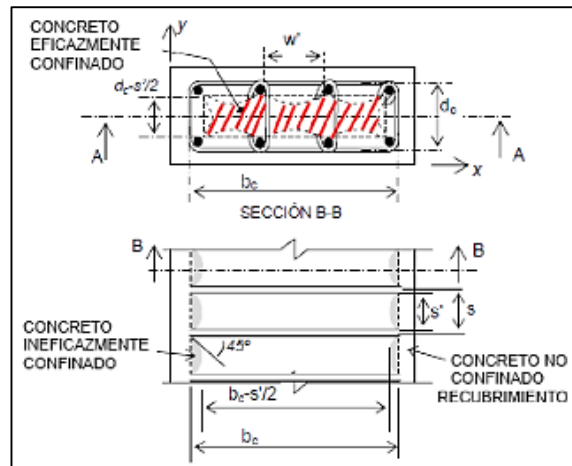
Secciones transversales tipología del refuerzo longitudinal y transversal.
